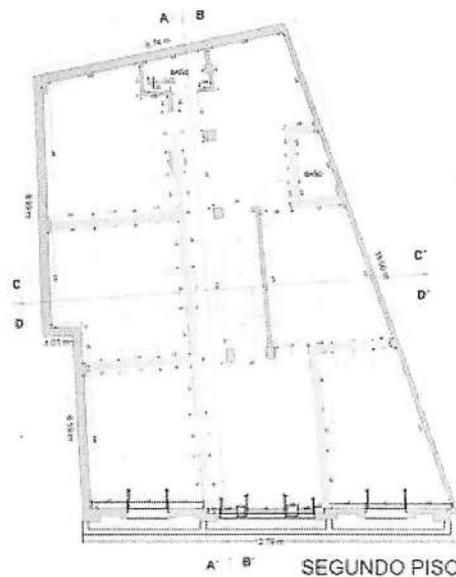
Plano de levantamiento (muros propuestos a demoler)
